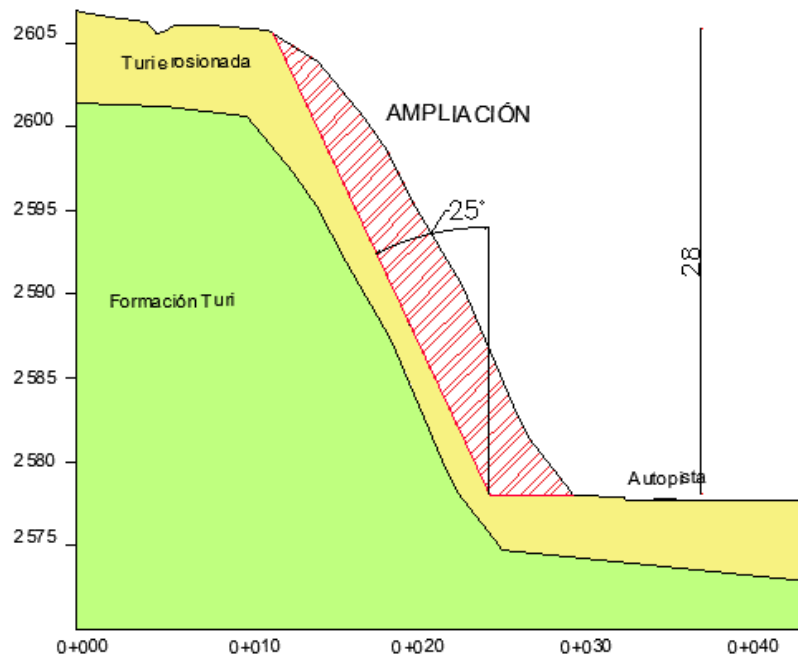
Geometría del talud propuesto – Soil nailing, talud 12 de Octubre.
